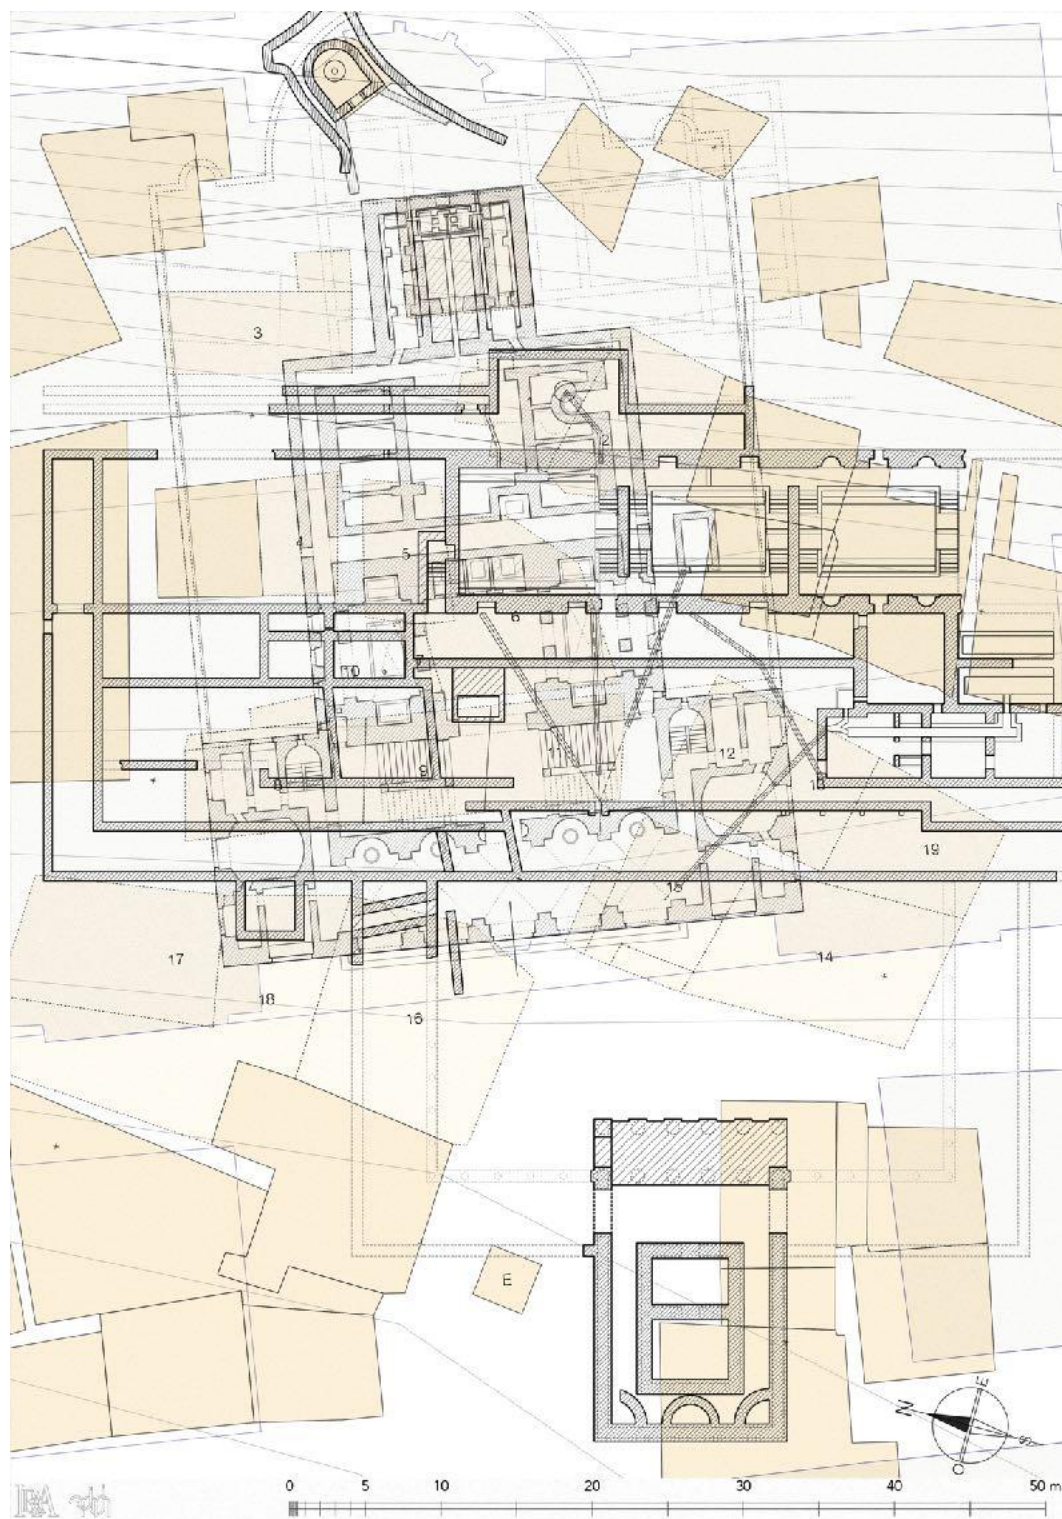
Plan des vestiges superposés aux thermes de Ledru (traits grisés), au plan du village en 1816 avant la démolition des maisons (en beige) et au cadastre de 2017 (traits bleus, fond gris), 1/500.
